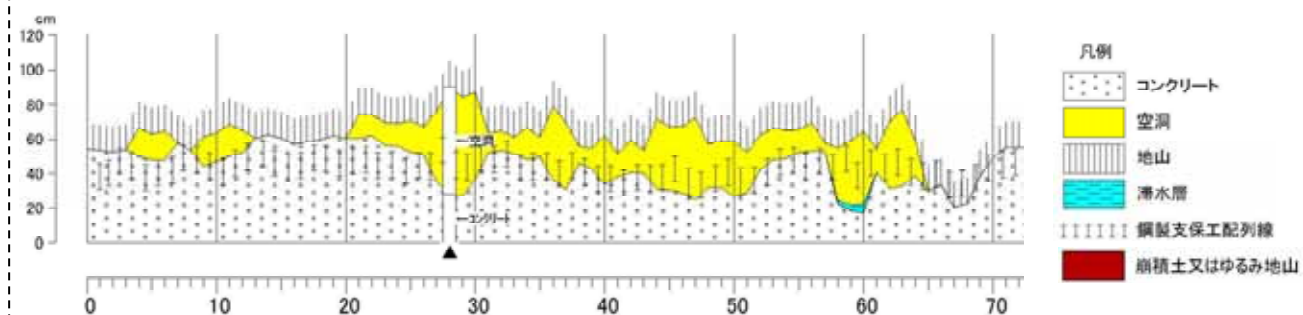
レーダー探査結果による分布状況縦断面図例
